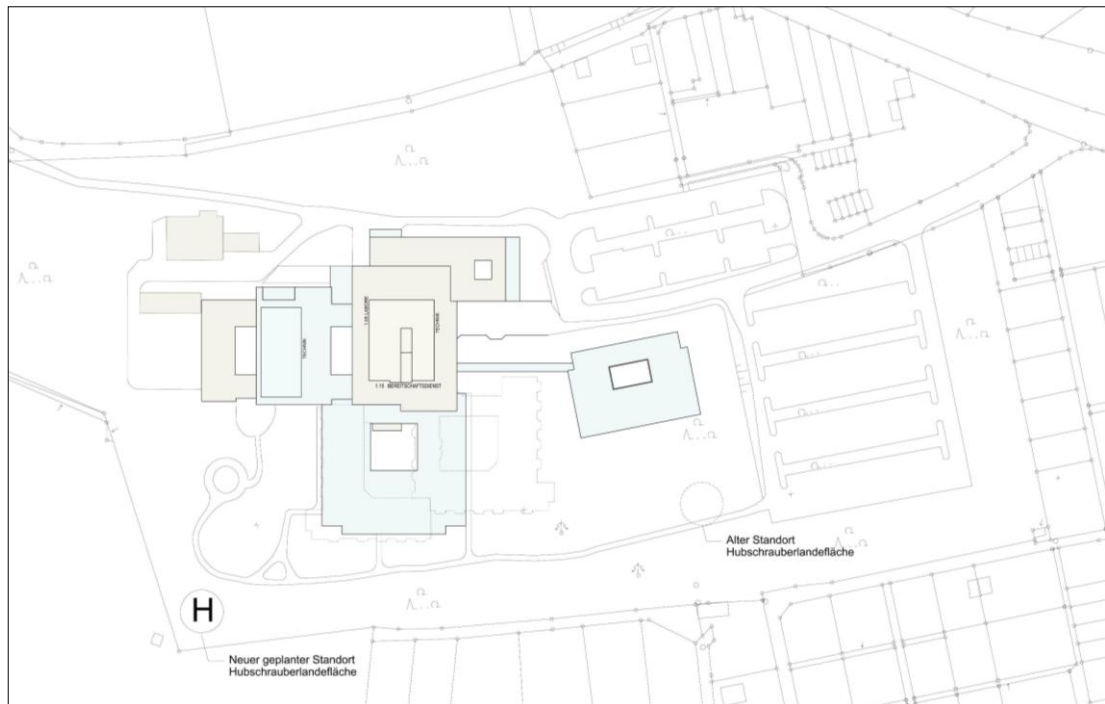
Momentaner Planungsstand für die Sanierung und den Umbau der Klinik Kitzinger Land, unmaßstäblich
